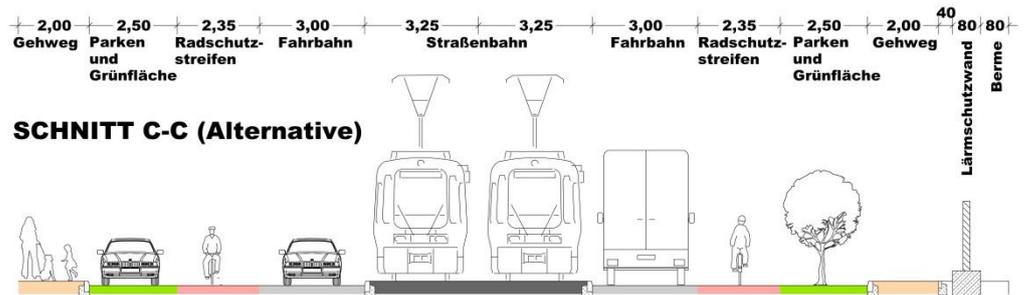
Trassenvariante 1a – Straßenquerschnitt Ost/West-Spange mit Straßenbahn in Mittellage (Alternativlösung)
